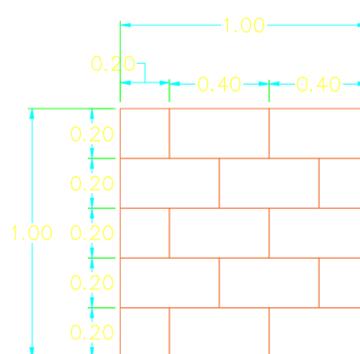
Distribución de mampostería construida con Brickaffix.
